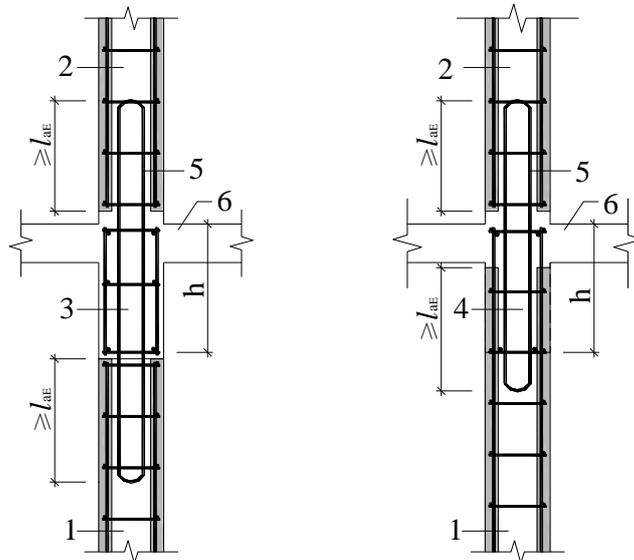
剪力墙端部钢筋搭接构造示意
